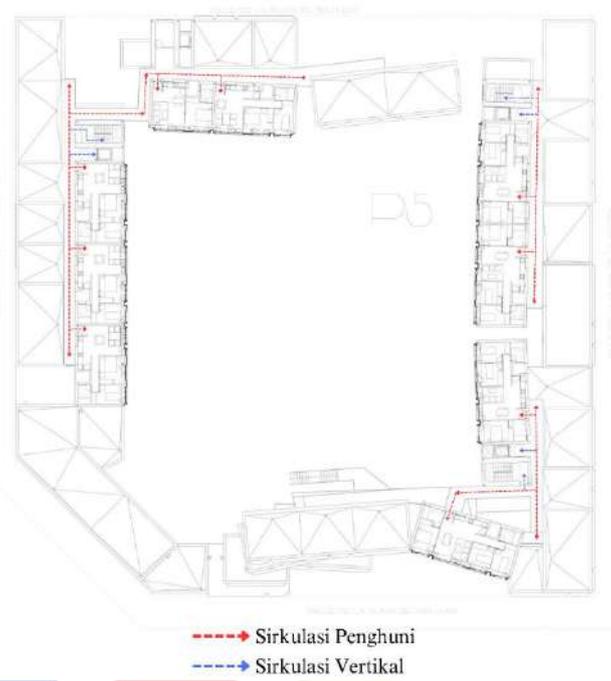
Denah Sirkulasi 3rd Floor BSH
